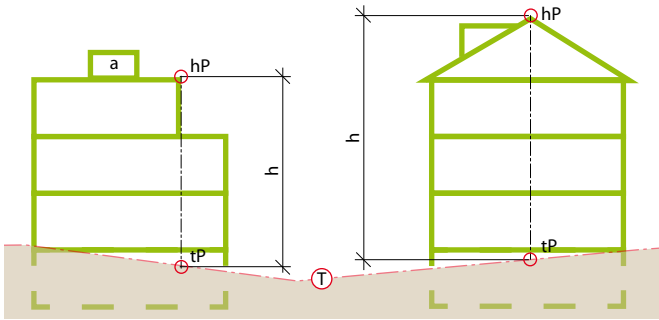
Gebäudegeometrie; T = massgebendes Terrain, h = Gesamthöhe, tP = tiefster Punkt auf massgebendem Terrain unter der Dachfläche, hP = höchster Punkt der Dachkonstruktion, a = technisch bedingte Dachaufbaute
